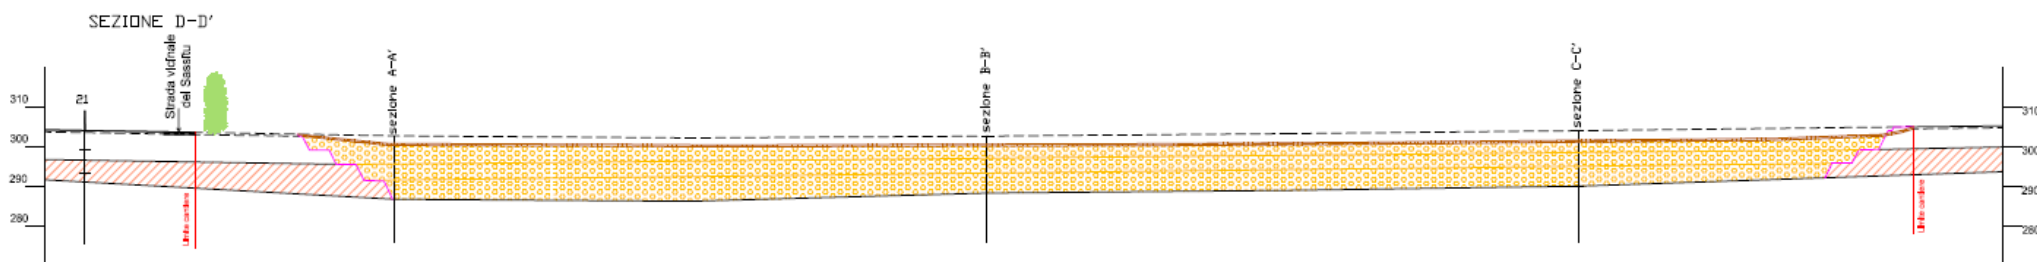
Stralcio sezione longitudinale di progetto (cumulativa) estratta dalla Tav. 6.2 del progetto approvato.
